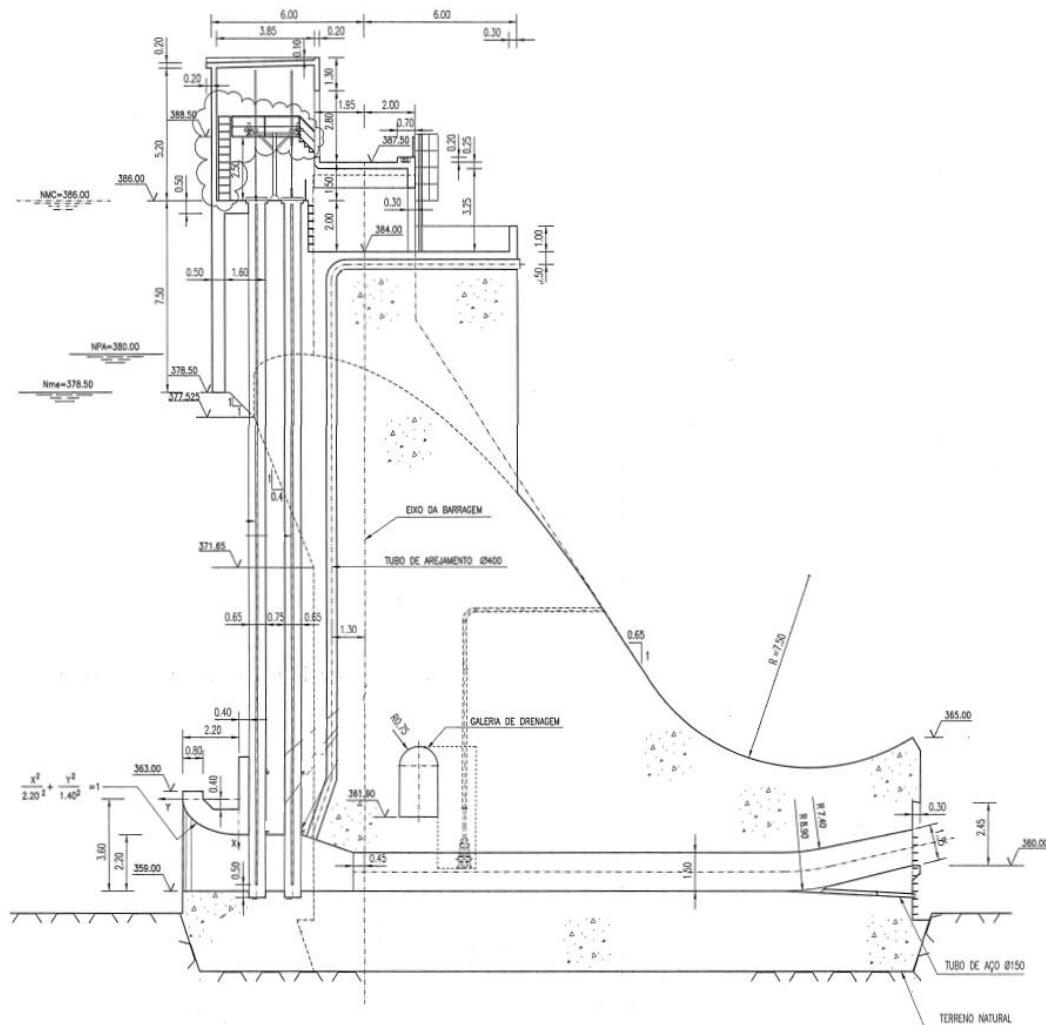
Corte longitudinal da barragem de Rebordelo – descarregador de cheias e descarga de fundo.
